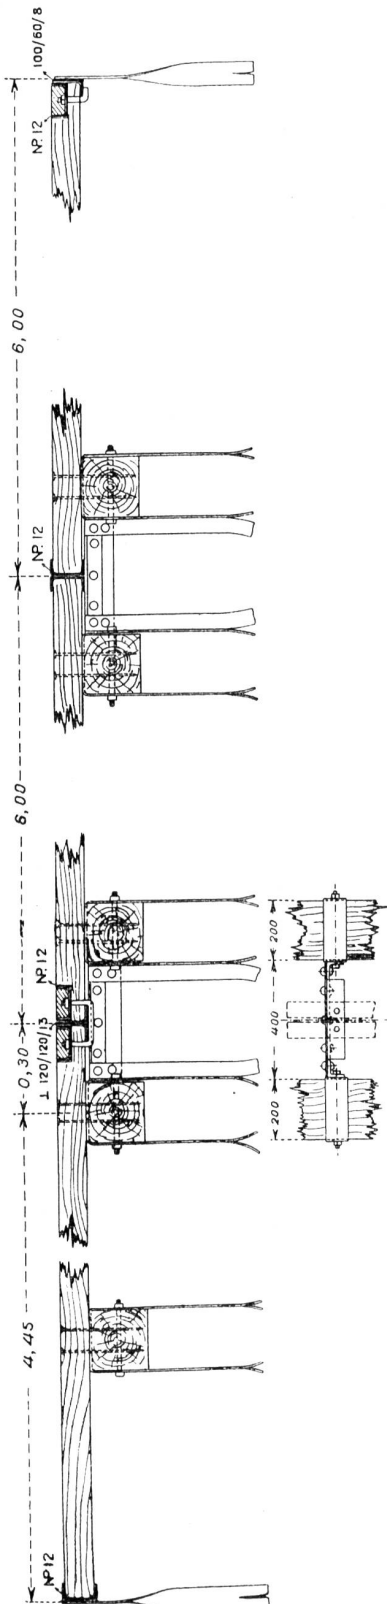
Abfallboden. Details der Befestigungen des Bohlenbelags. Schnitt parallel zur Flussrichtung. Maßstab 1 : 25.
